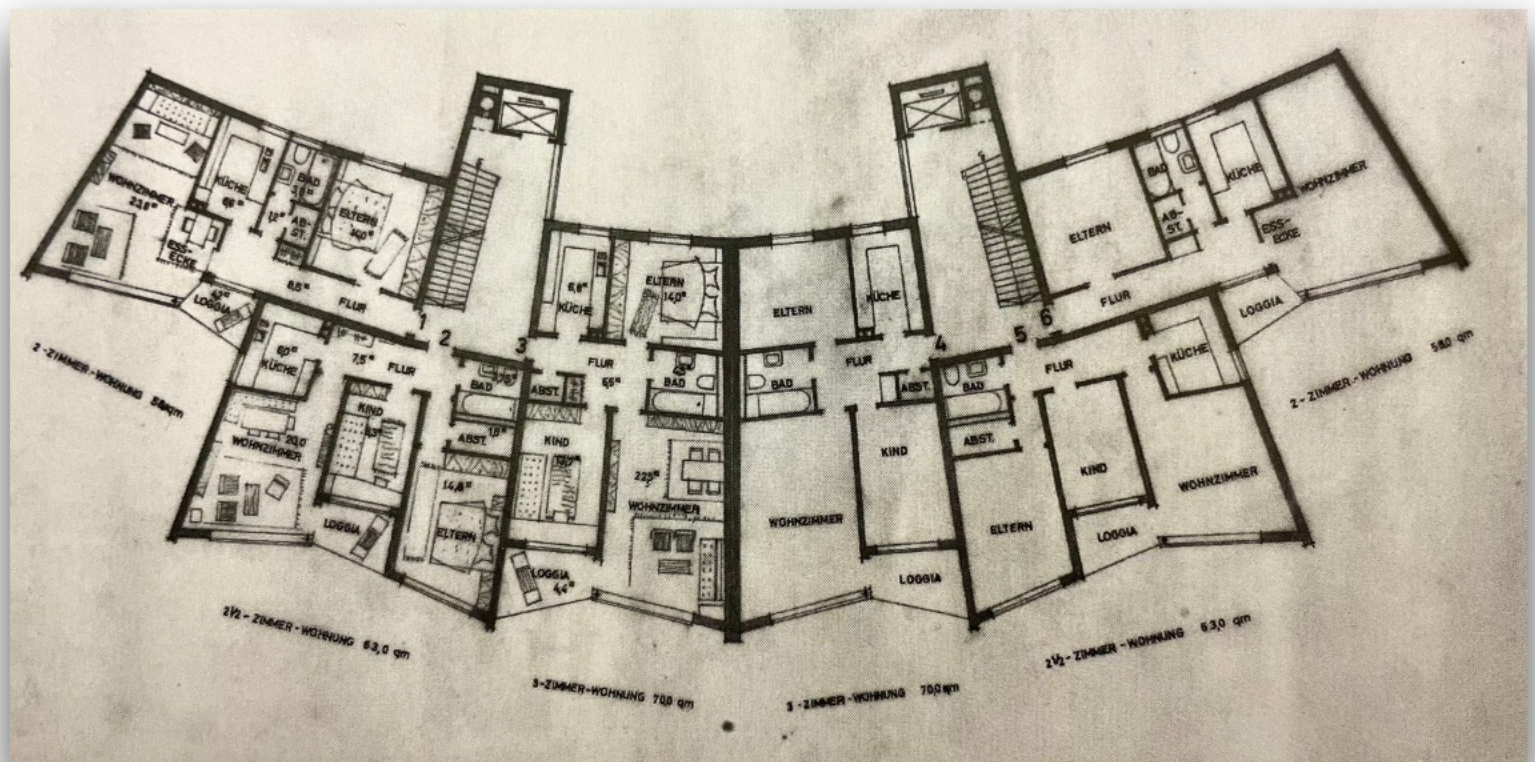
Hochhausgrundriss, Normalgeschoss, Vorschlag 3, 19.06.1963
